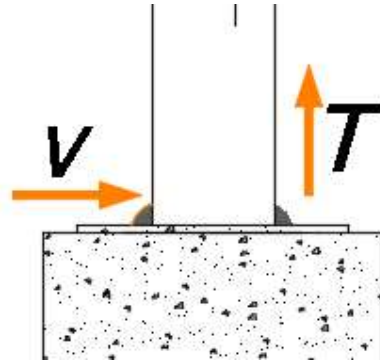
Fuerzas actuantes sobre la soldadura
